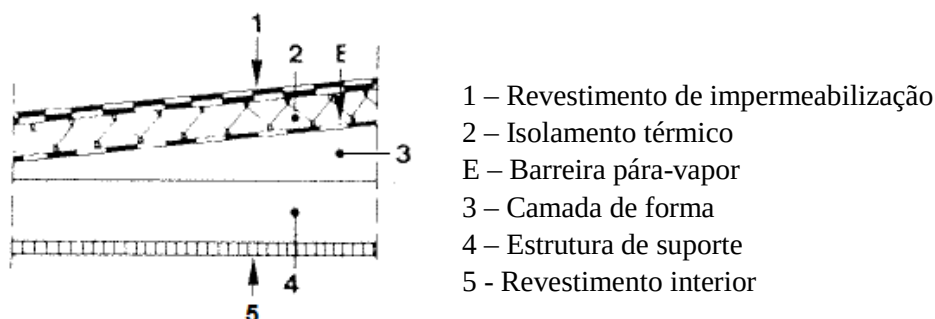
Constituição de coberturas em terraço em que a camada de impermeabilização é colocada sobre a camada de isolamento térmico [10]
